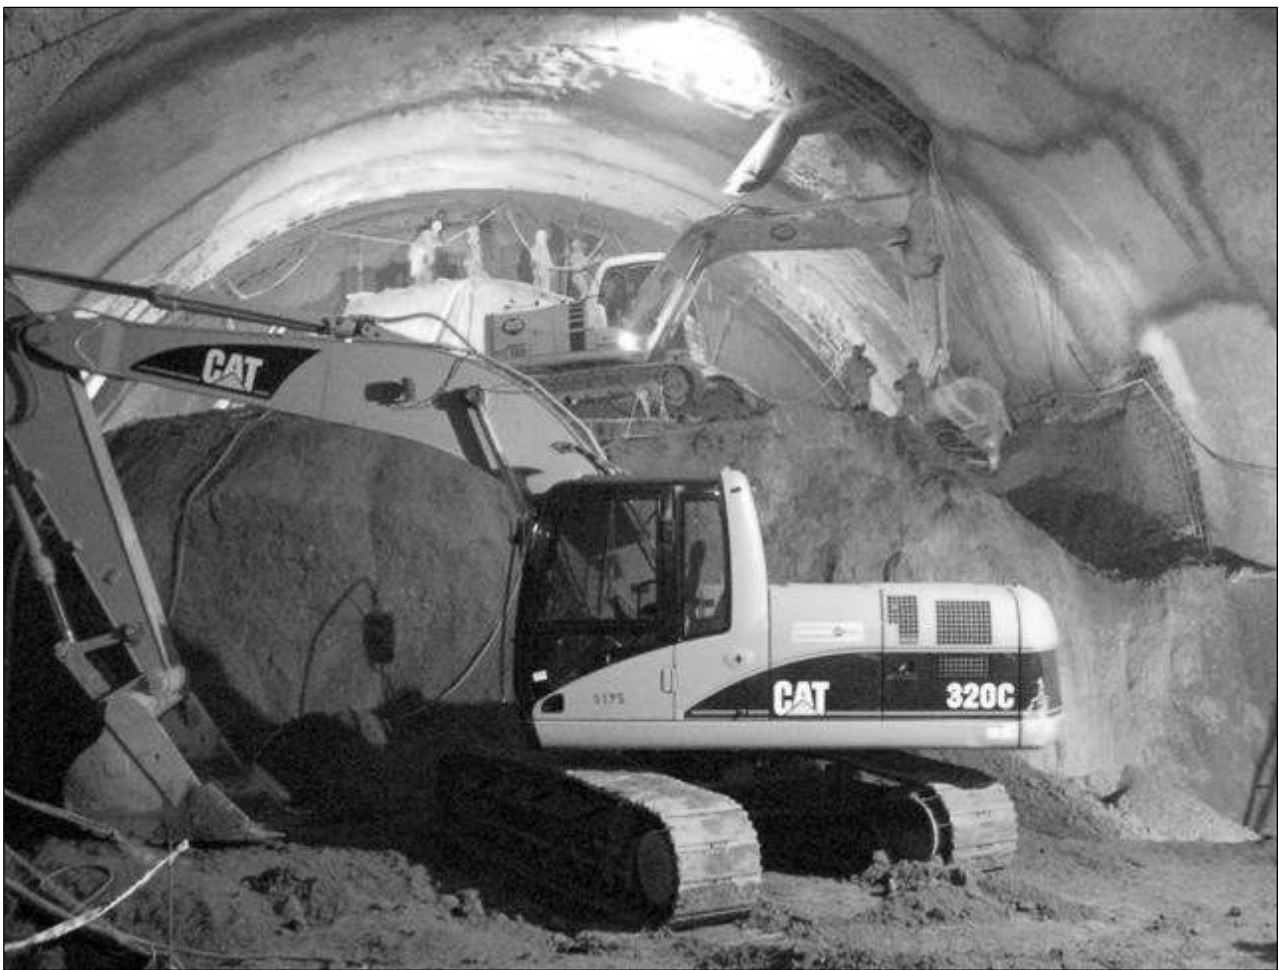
Vista de la caverna principal durante su construcción. Se aprecian dos retroexcavadoras grandes trabajando en paralelo.
